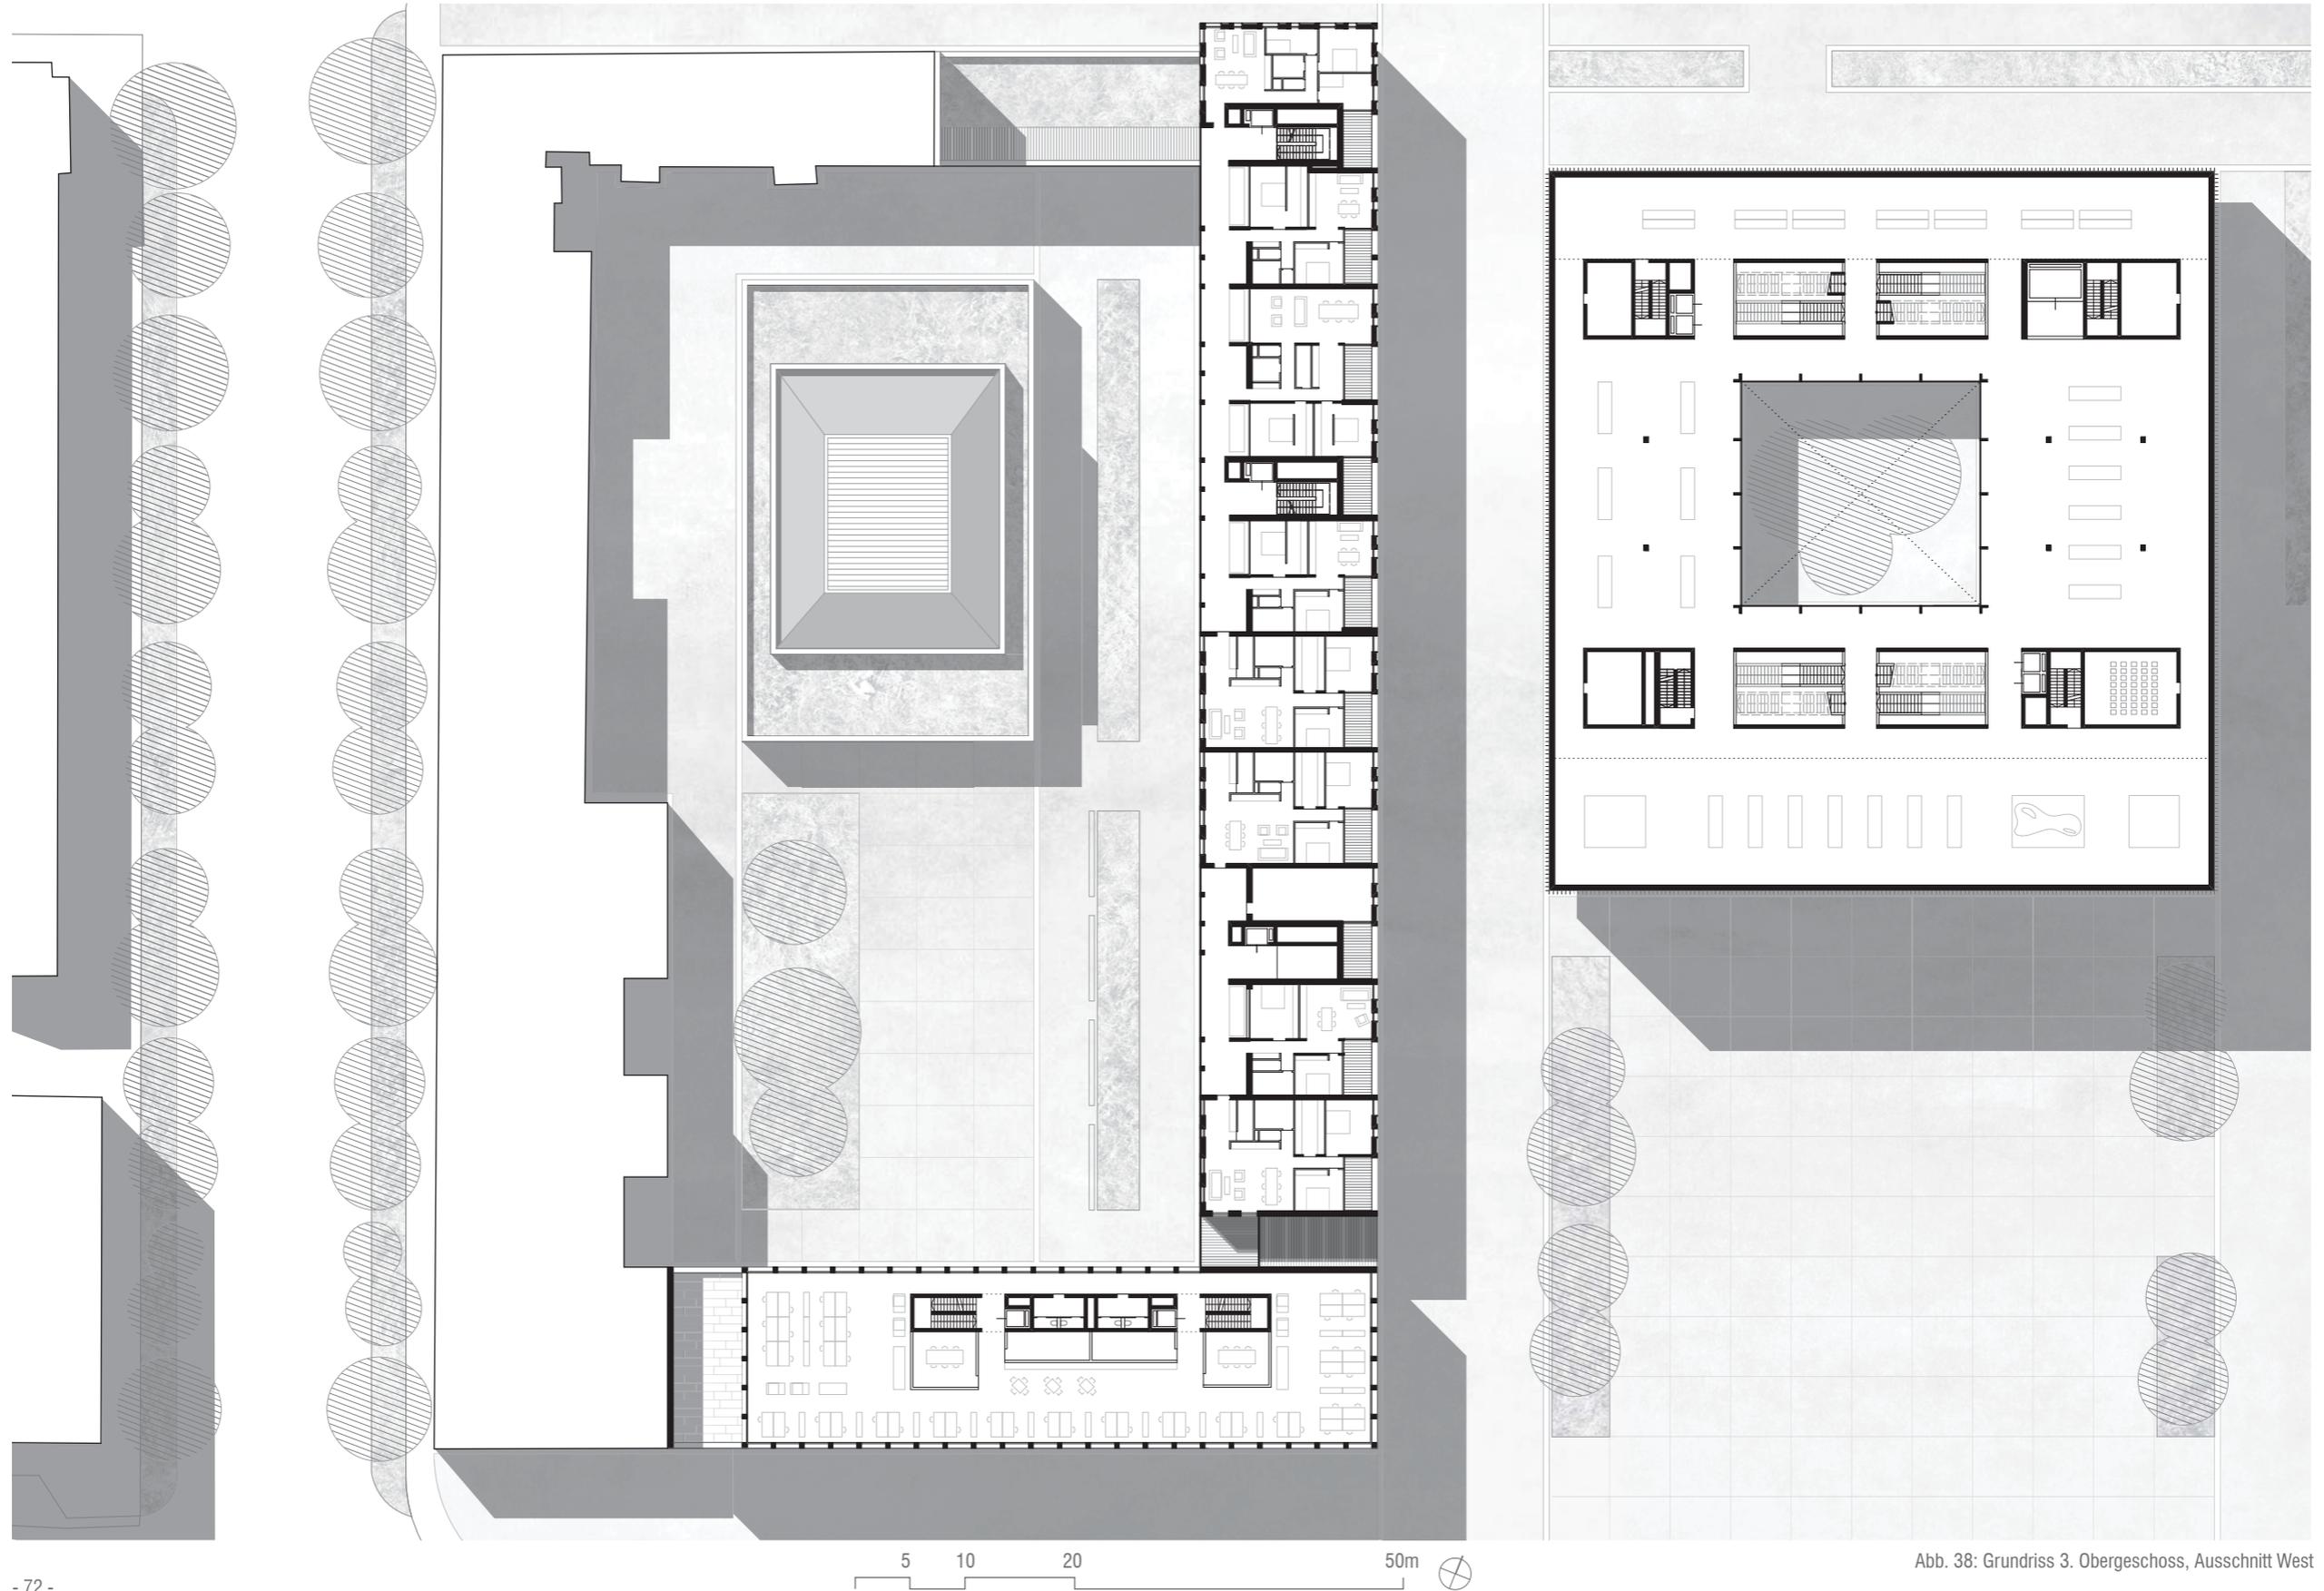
Grundriss 3. Obergeschoss, Ausschnitt West
